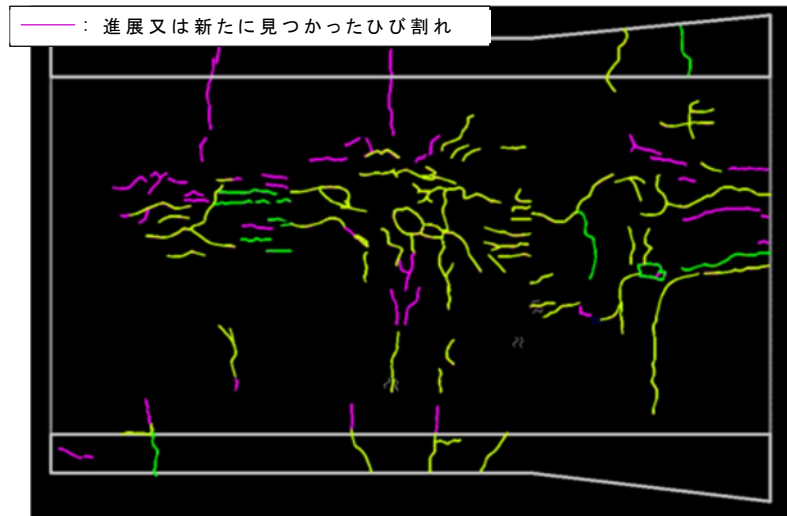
ひび割れの点検時期による変動例（重合せ）
